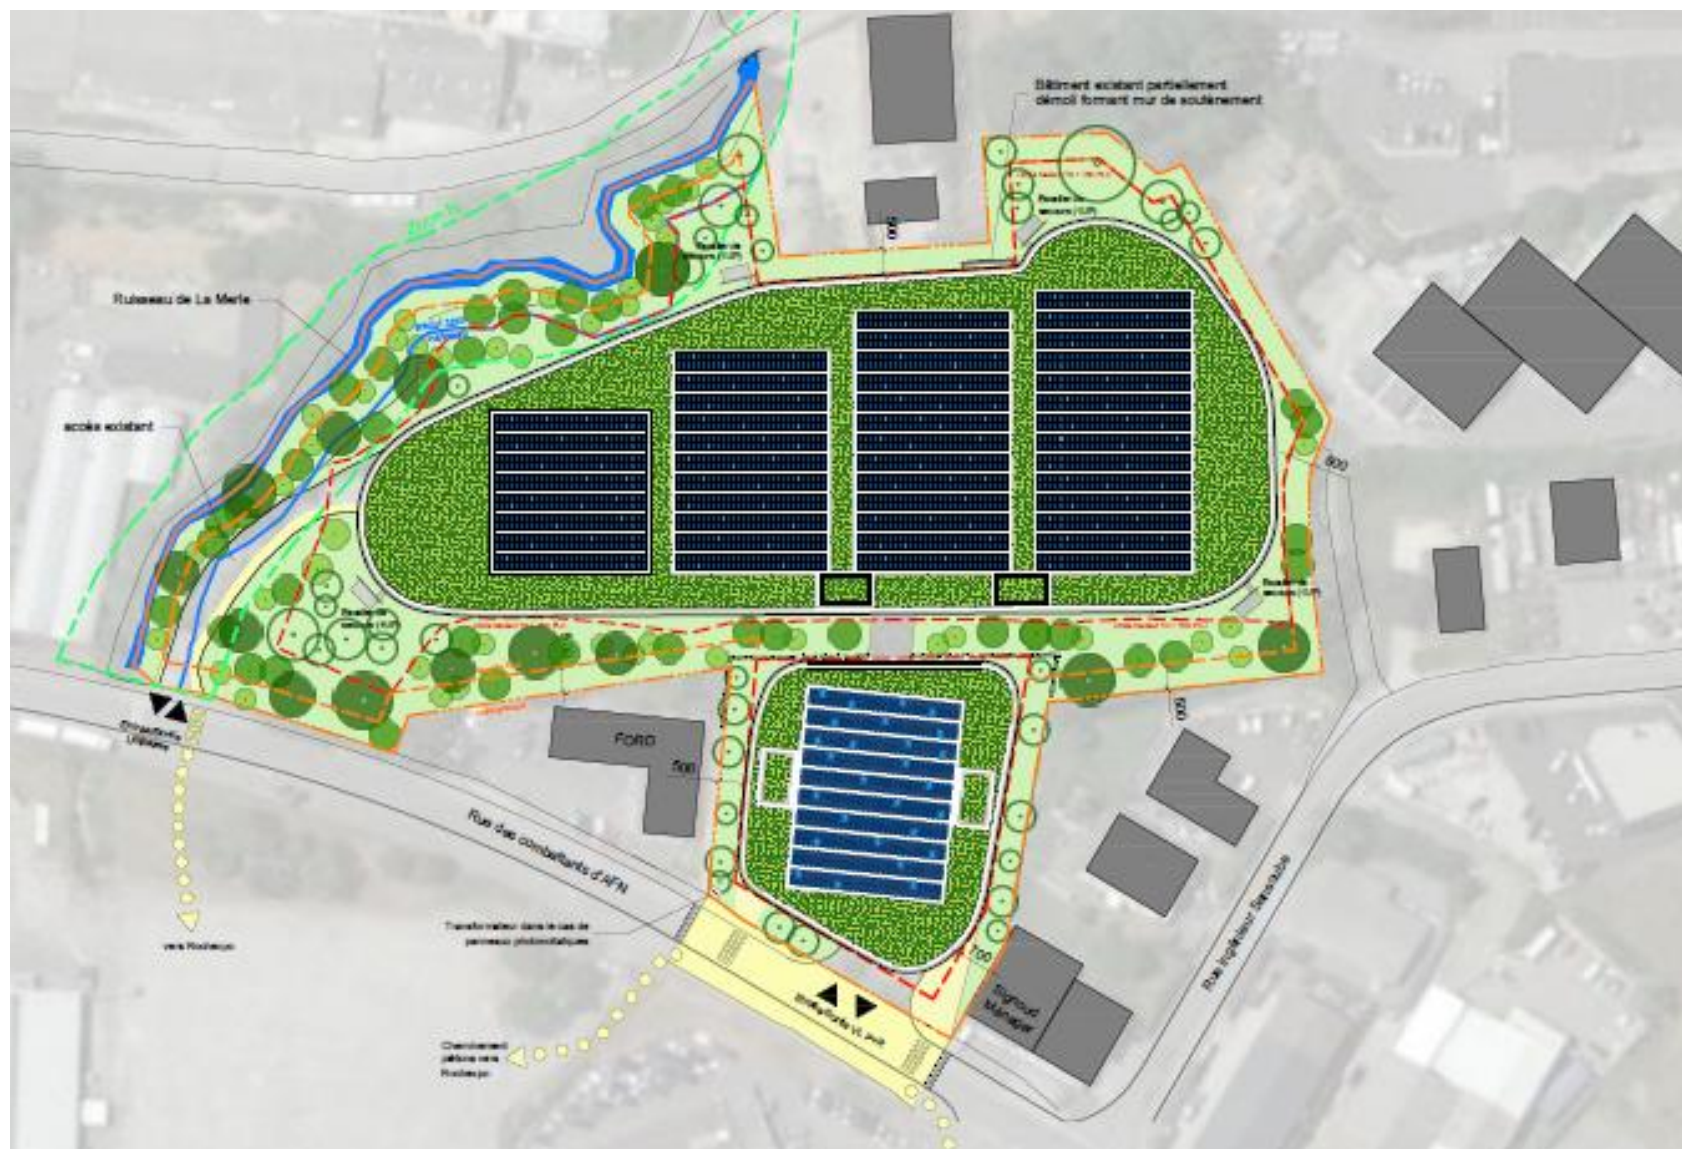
Plan de masse du parking en silo (Source : Ritz Architecte)
